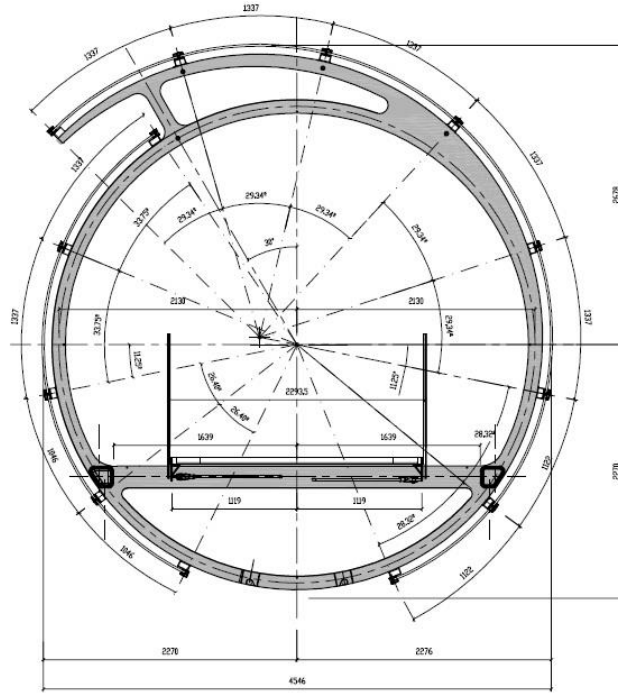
Elemento metálico de forma anelar da ponte da Fundação Champalimaud [24]
